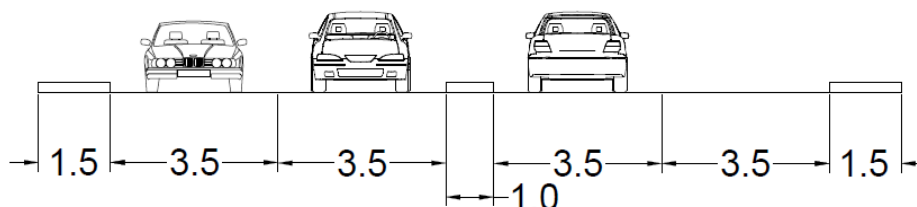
Sección Transversal Av. Máximo Gómez. (Fuente: Elaboración Propia).
